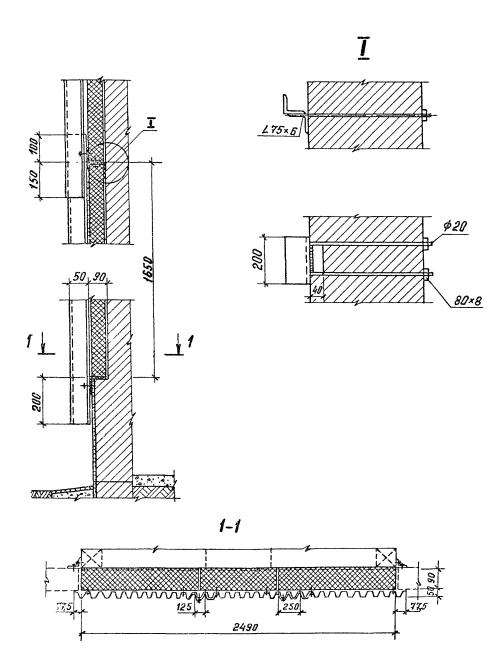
Устройство вентилируемой стеновой конструкции
